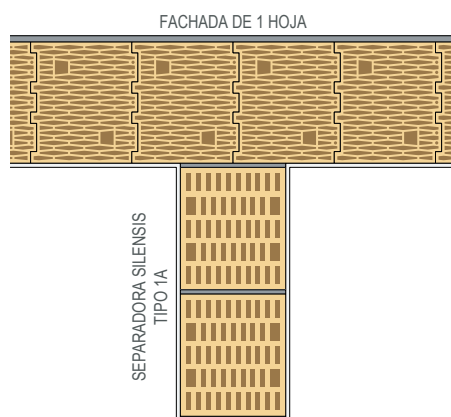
Encuentro de separadora Silensis Tipo 1A con fachada de una hoja.
